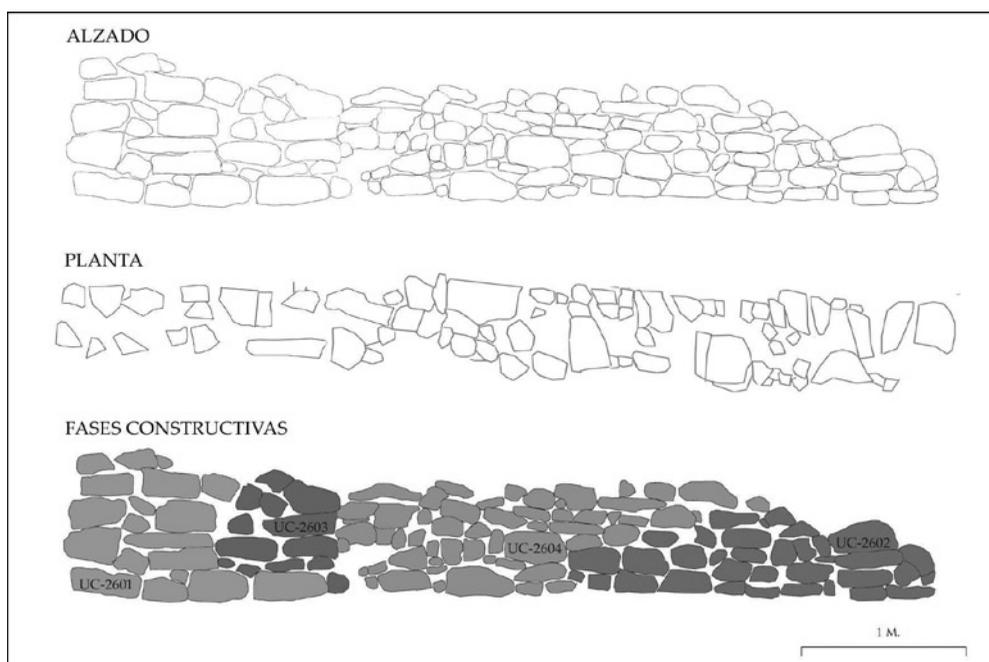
Alzado, planta y fases constructivas de G.U.C. 2600
